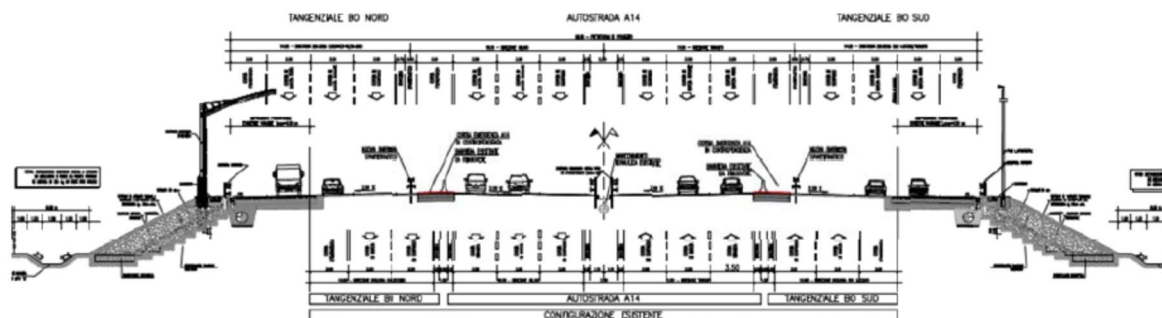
Sezione di progetto su tratto in rettilifilo.
